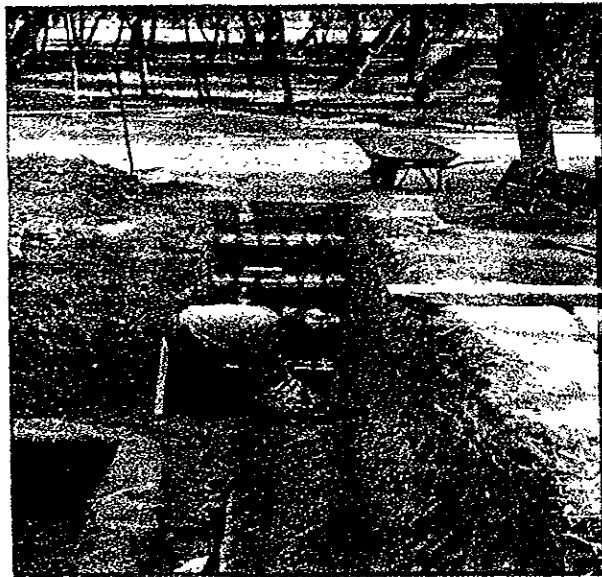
Construcción de las escaleras de acceso al HAFH.
